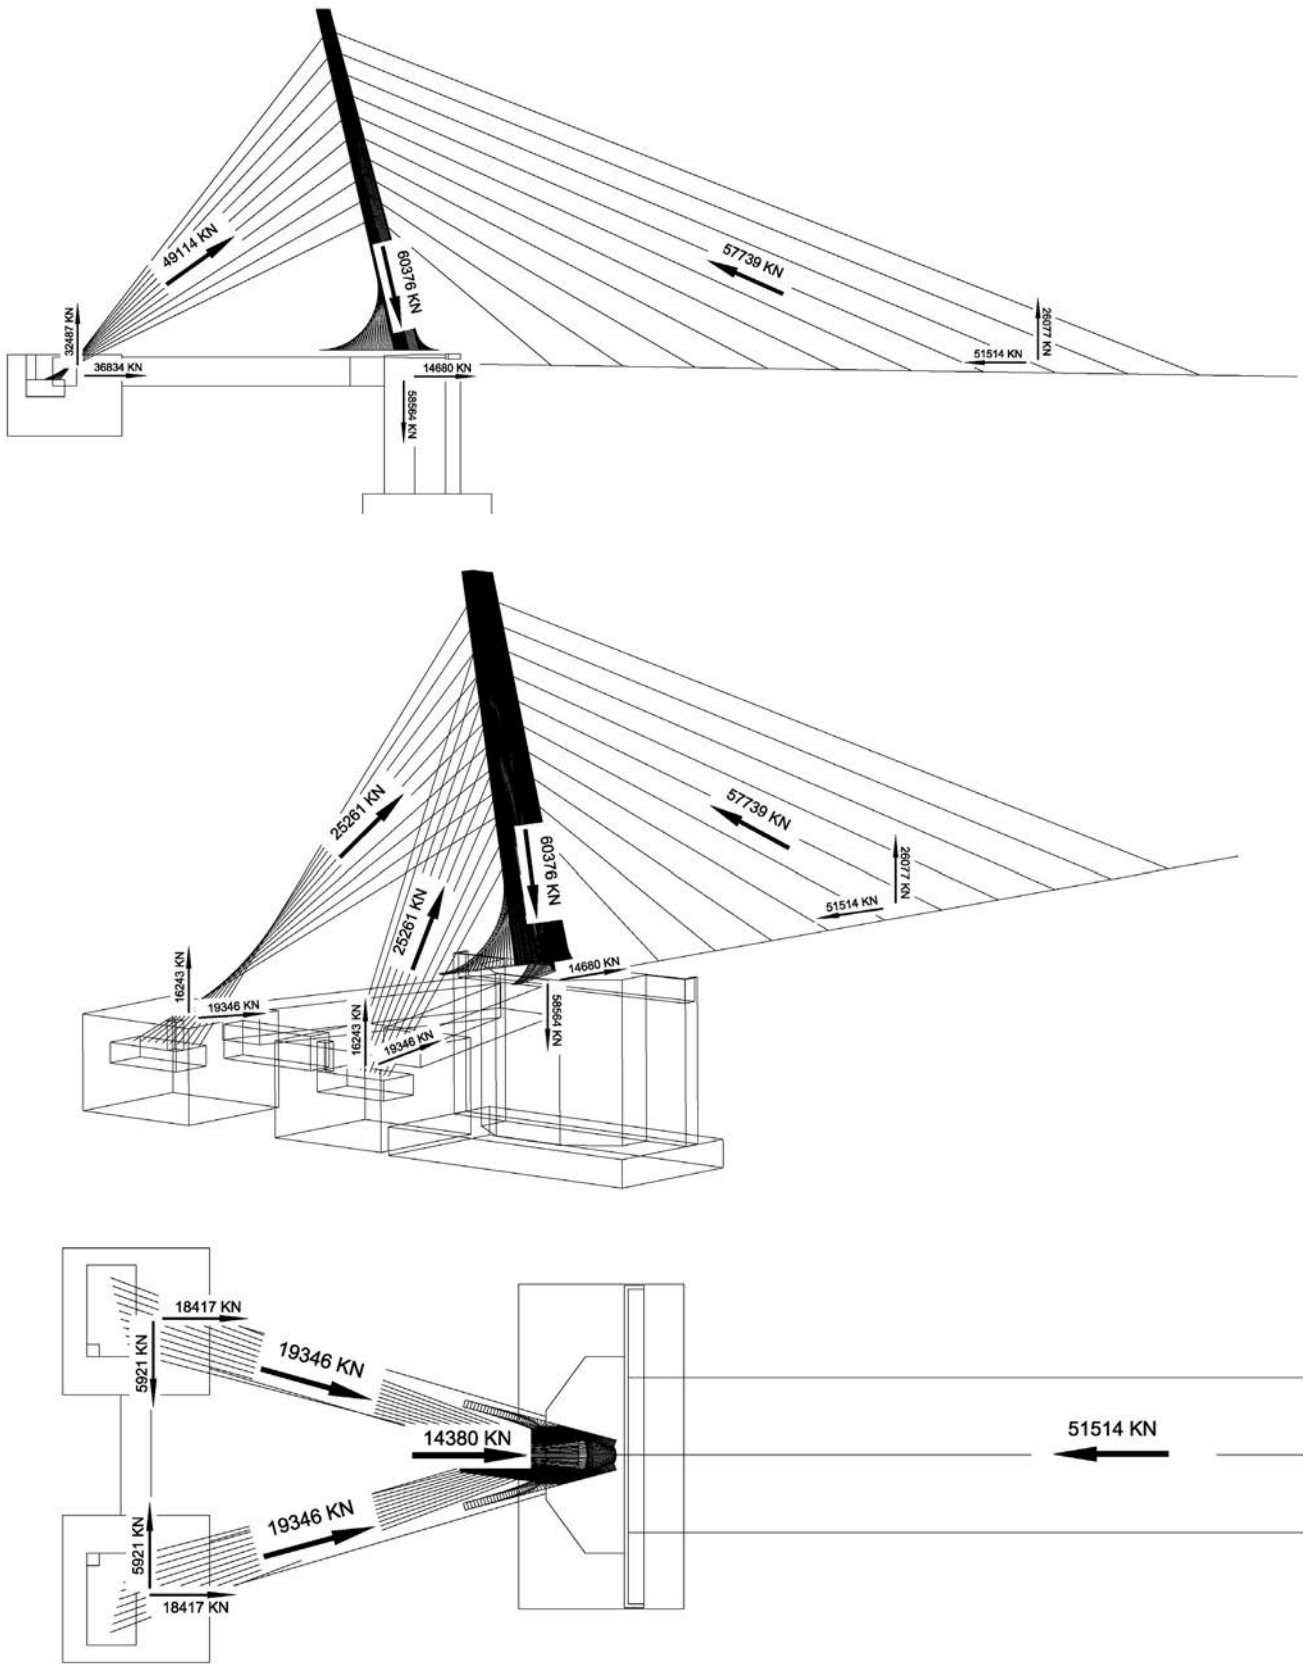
Sistema de fuerzas introducido por el atirantamiento.
